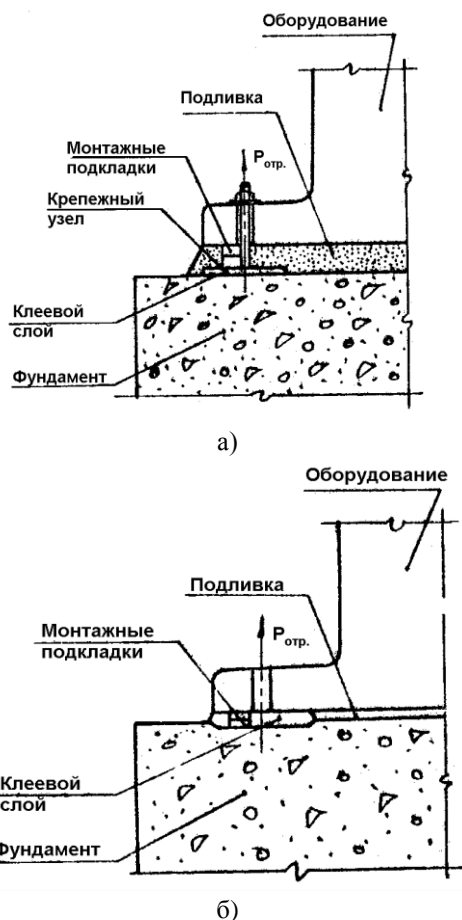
Кріплення обладнання шляхом приклеювання кріпильного вузла (а) і опорної частини обладнання (б) до поверхні бетону фундаменту
